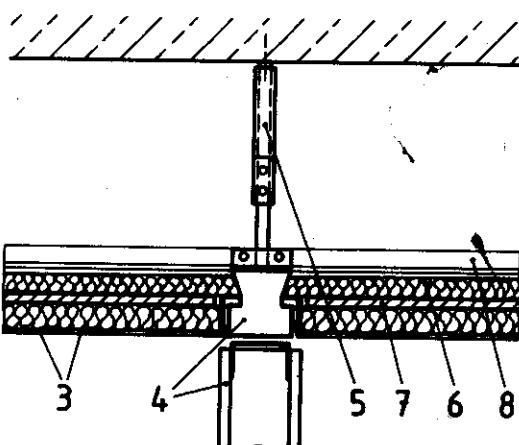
Unterdecke mit Bandprofilen und perforierten Metall-Deckenplatten in Einlegemontage
